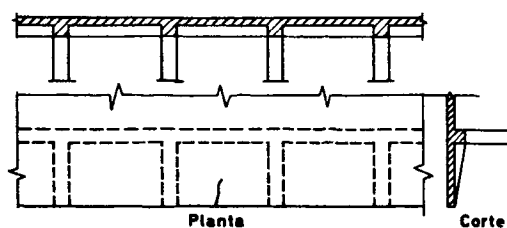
Grietas por retracción en un sistema de losas con un solo borde libre. Citado por Bukowski¹.
